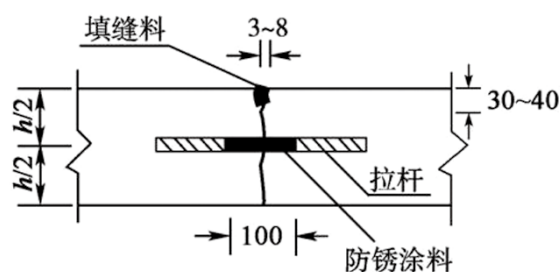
纵向施工缝构造 (尺寸单位: mm)
